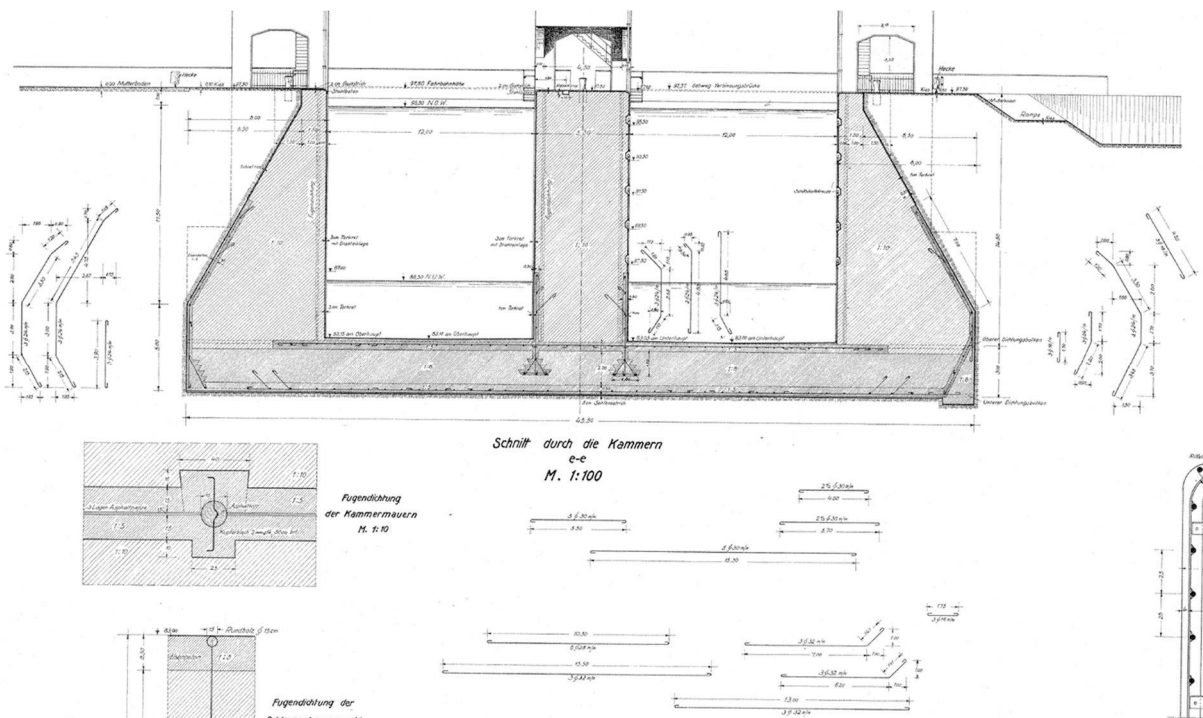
Regelschnitt der Doppelschleuse im Kammerbereich, Blickrichtung Unterwasser
